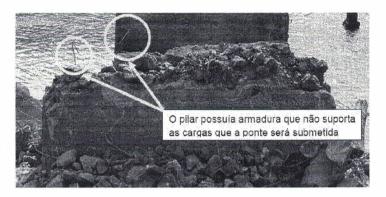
Fissura Trasnversal Pilar 9
